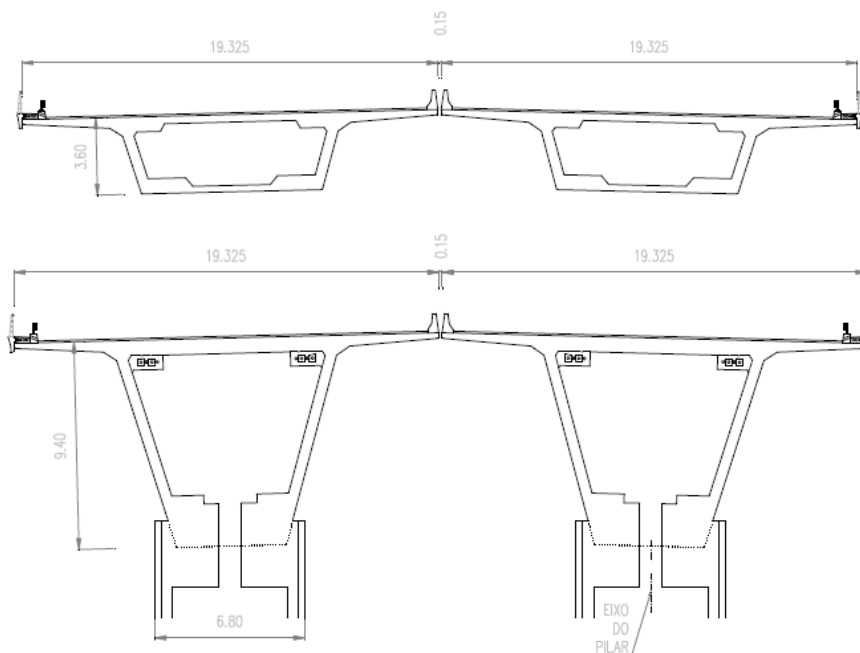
Secção transversal em caixão, principais dimensões.
